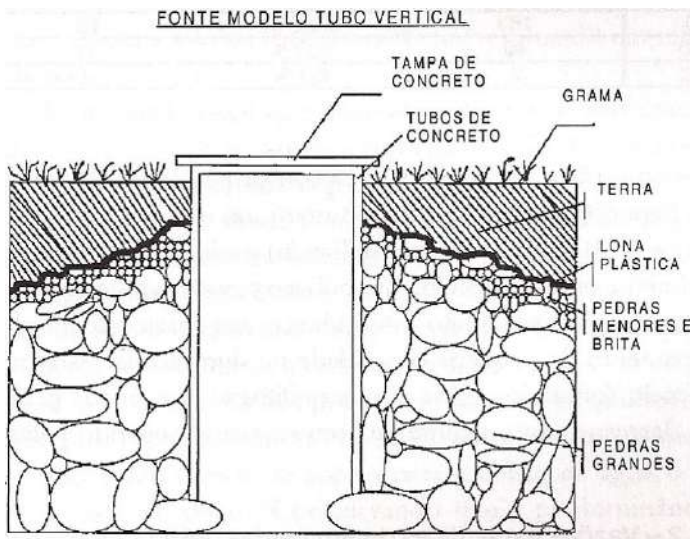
Esquema de construção da proteção de fonte Modelo Tubo Vertical
